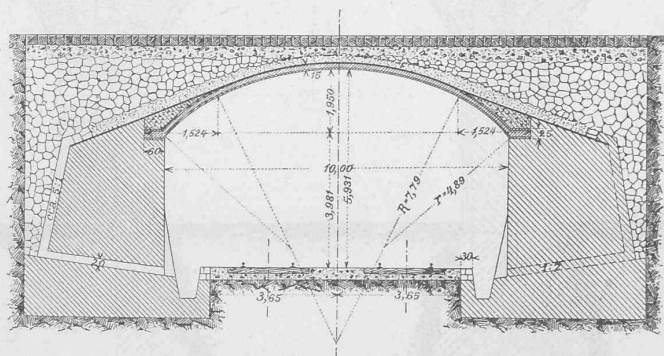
Ueberfahrtsbrücke in Monier-Konstruktion. Längsschnitt. — 1 : 200.
